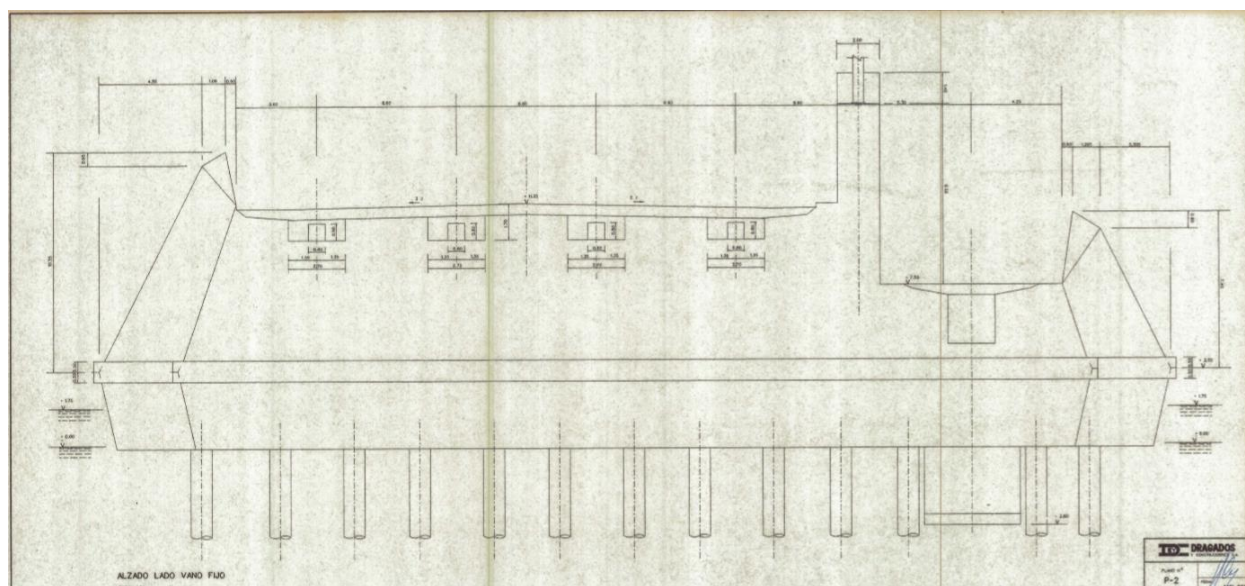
Alzado lado vano fijo (Pila 1). Fuente: Ayto. de Sevilla. Gerencia de Urbanismo.
